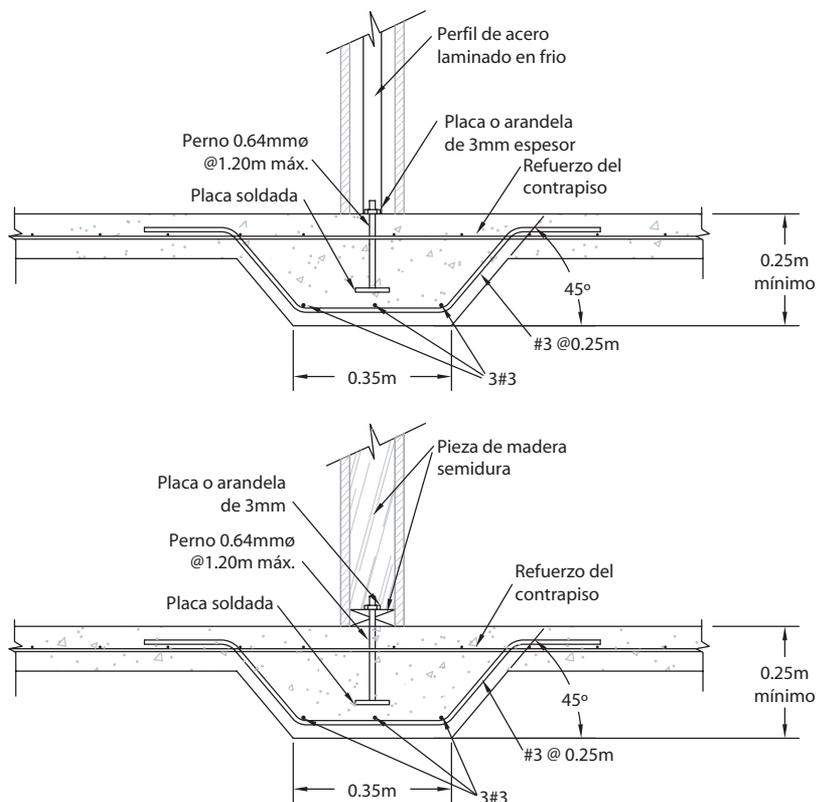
Fundación para planchas delgadas a doble forro.
